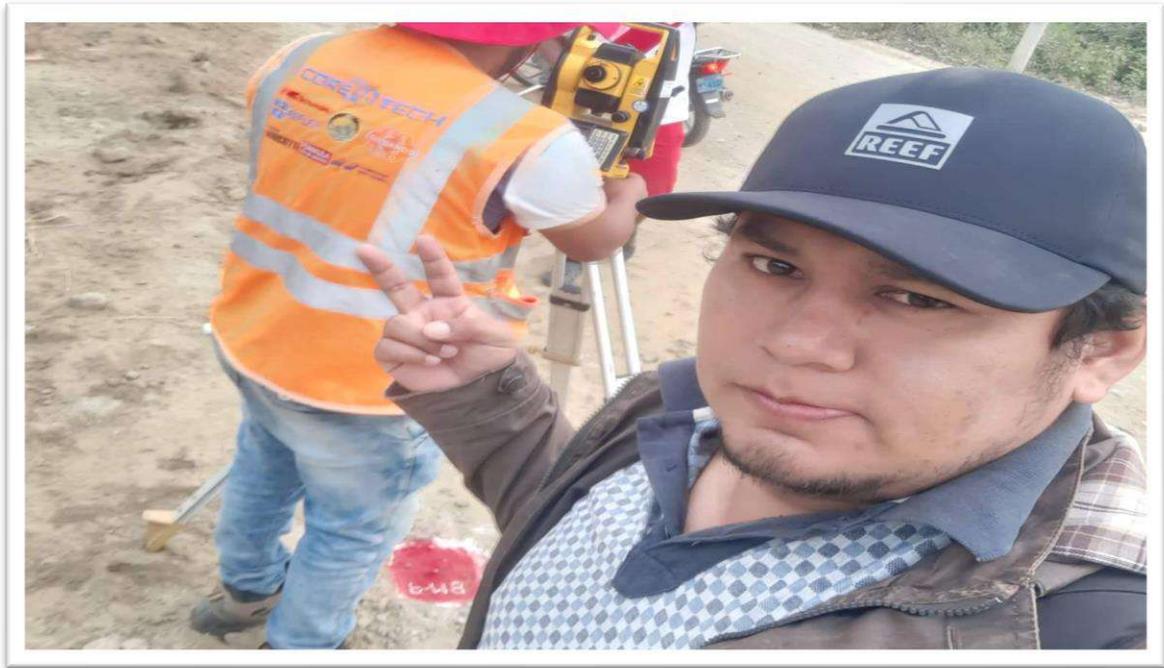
BM-09, NORTE: 9345473.82, ESTE: 632694.991, ELEVACIÓN: 128.134.
